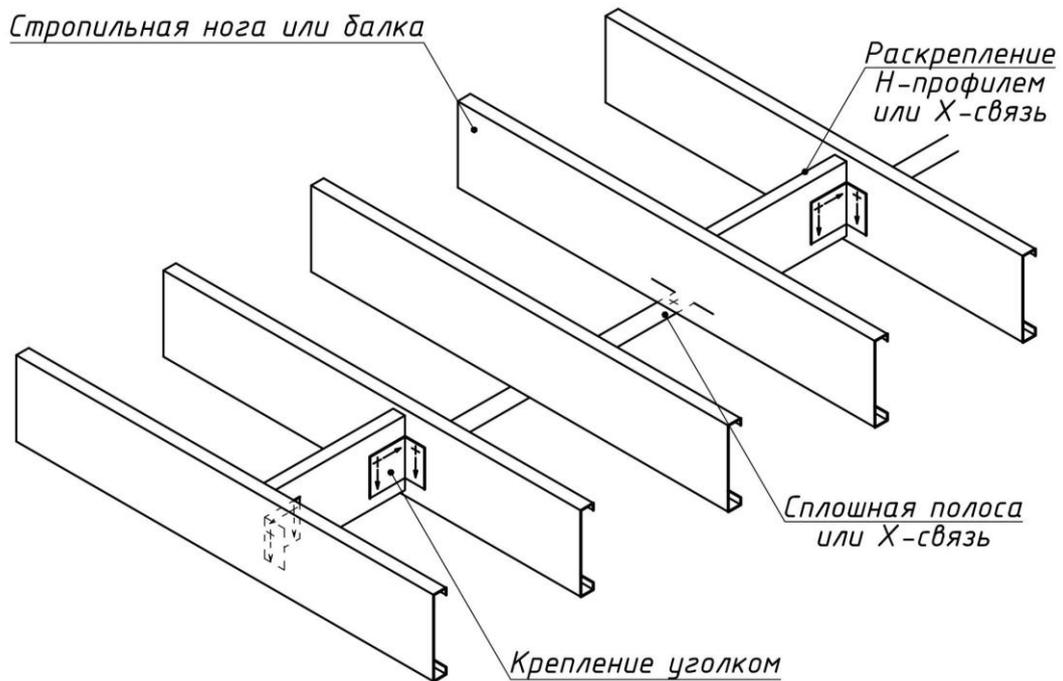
Узел К 8. Раскрепление стропильных ног или балок
